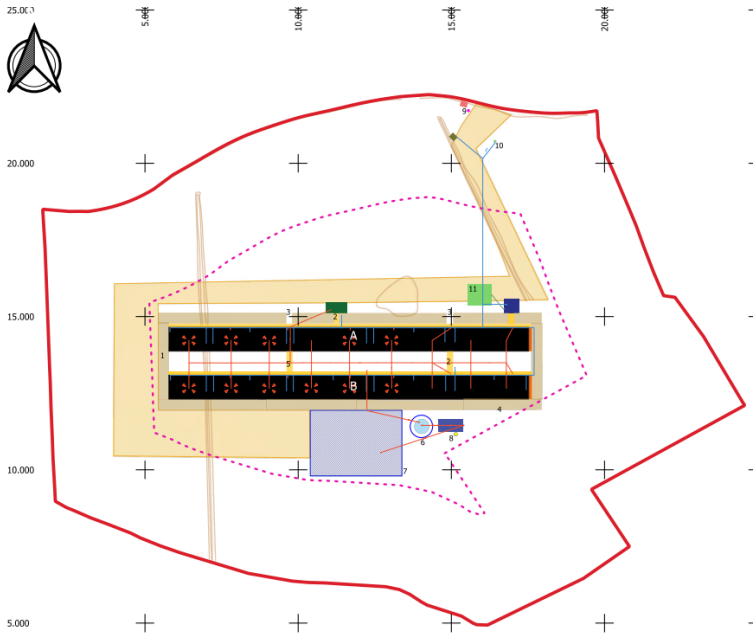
Planta de Implantação - Fonte: EIA_Desenhos
